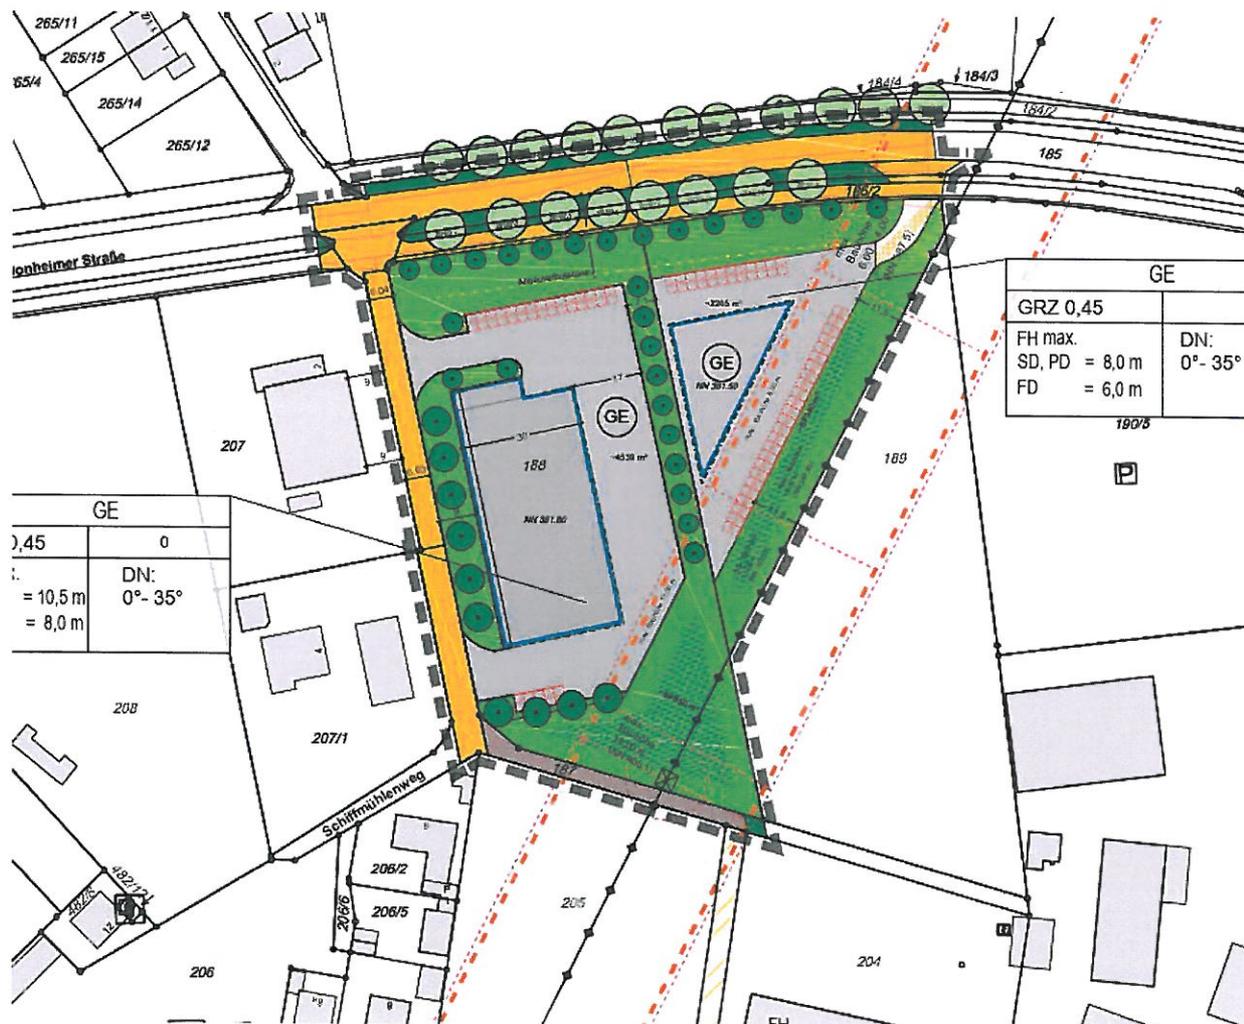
Auszug Planzeichnung Nr. 3-18 „Gewerbegebiet Monheimer Straße“
